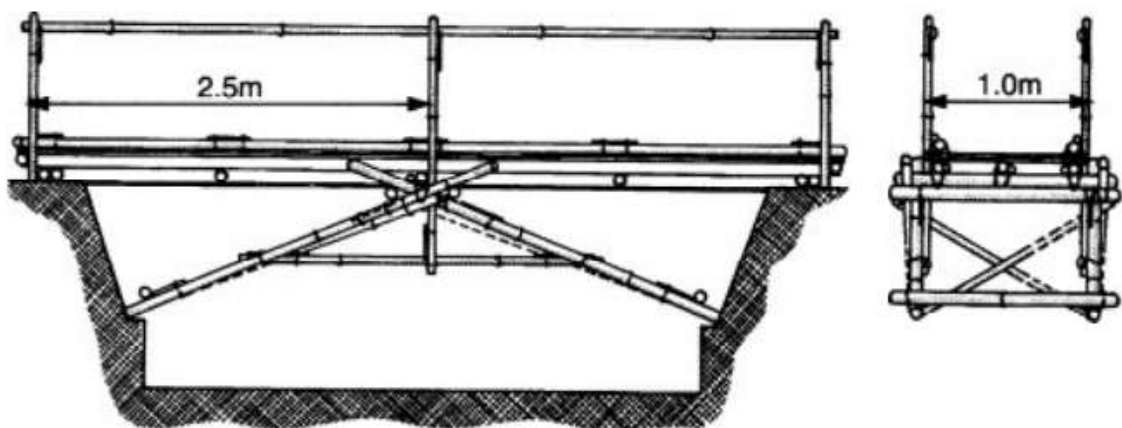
Estrutura de Ponte de treliça Simples [10]
